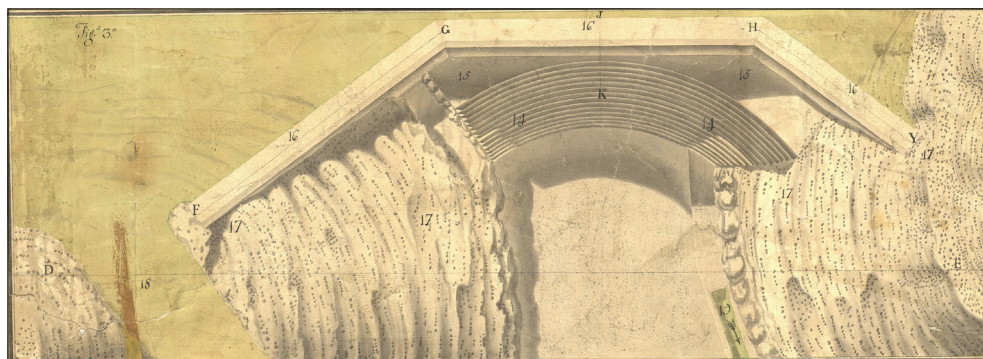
Planta del pantano con el recrecimiento proyectado (sección 4 del plano).
